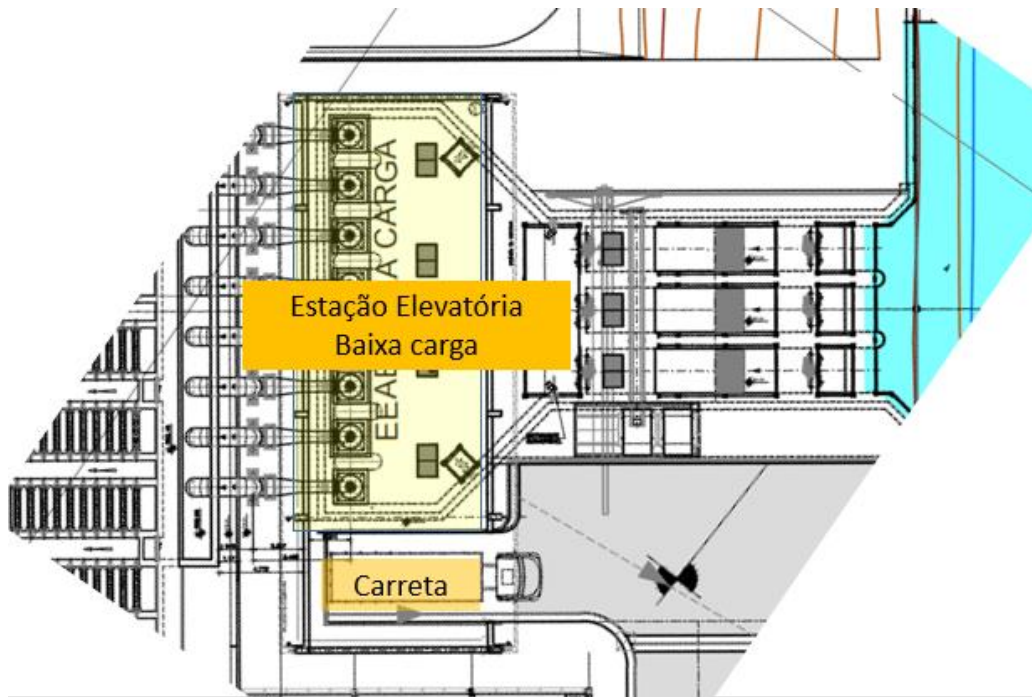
Estação Elevatória de Baixa Carga, Vista em Planta
